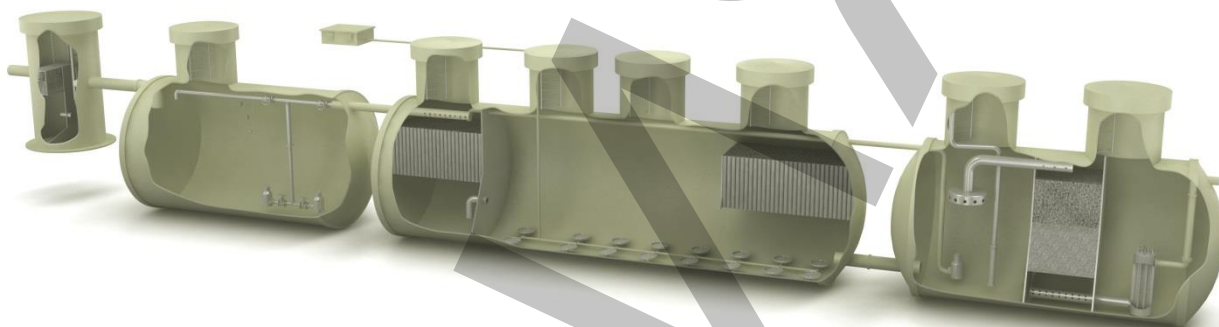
Внешний вид и устройство установки глубокой биологической очистки
